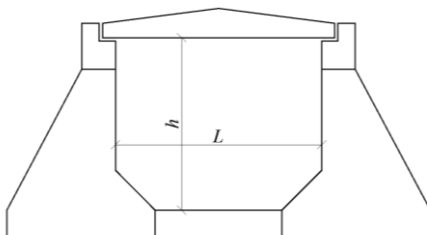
Поперечный разрез прямоугольной железобетонной трубы
